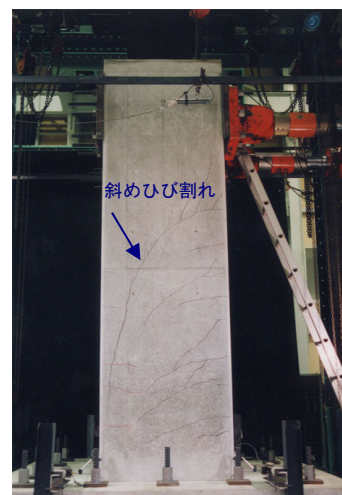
無補強载荷時の斜めひび割れ状況
